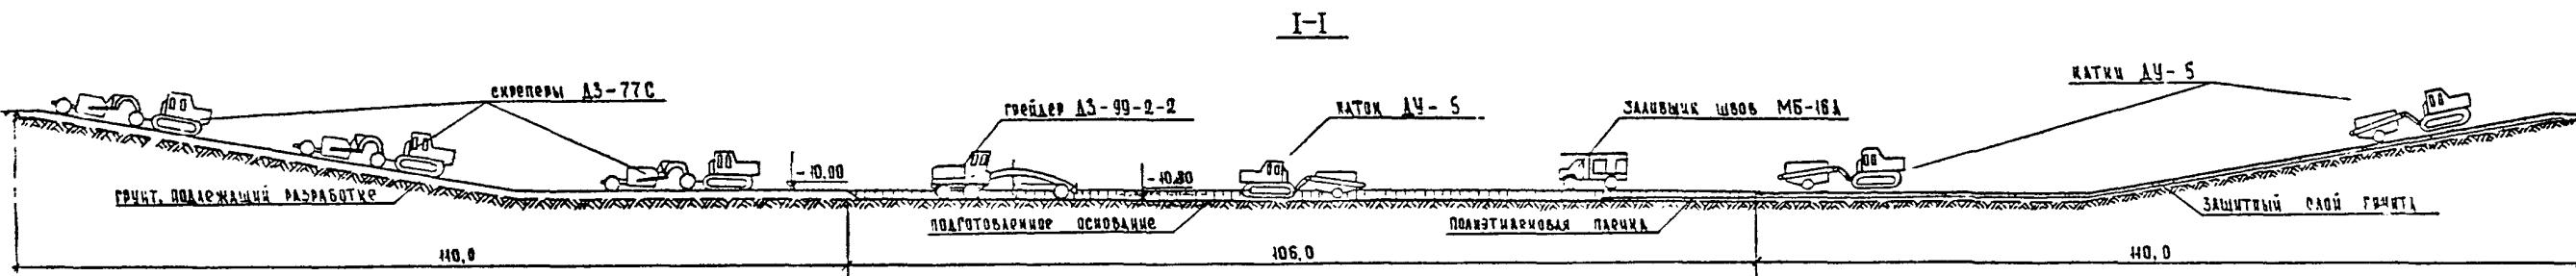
Схема производства работ по устройству грунтопленочного экрана на смежных захватках (участок I)
